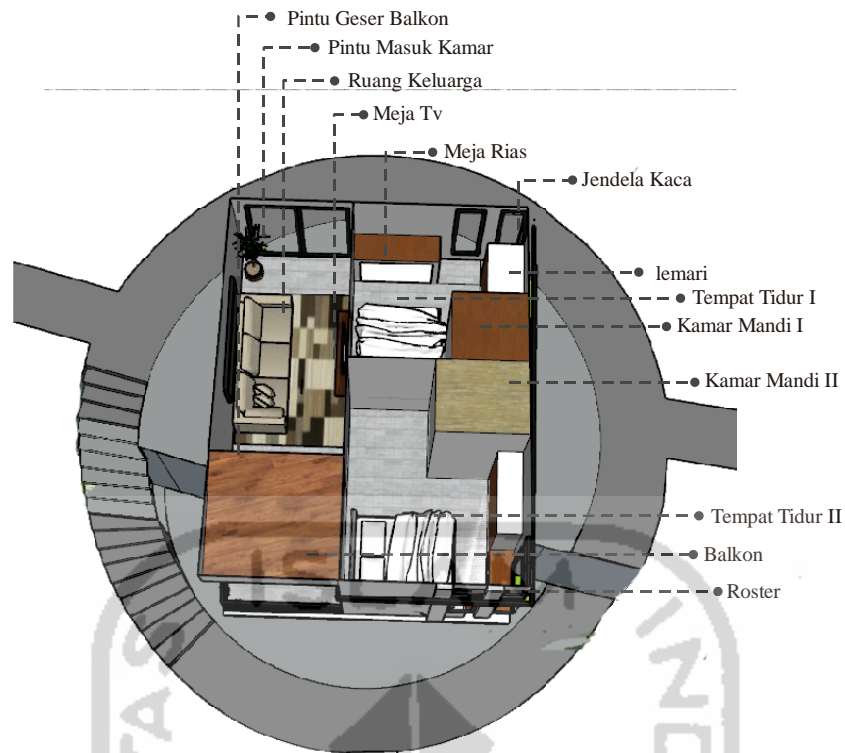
13 Konsep Material dan Struktur Bangunan Type Suite Room
